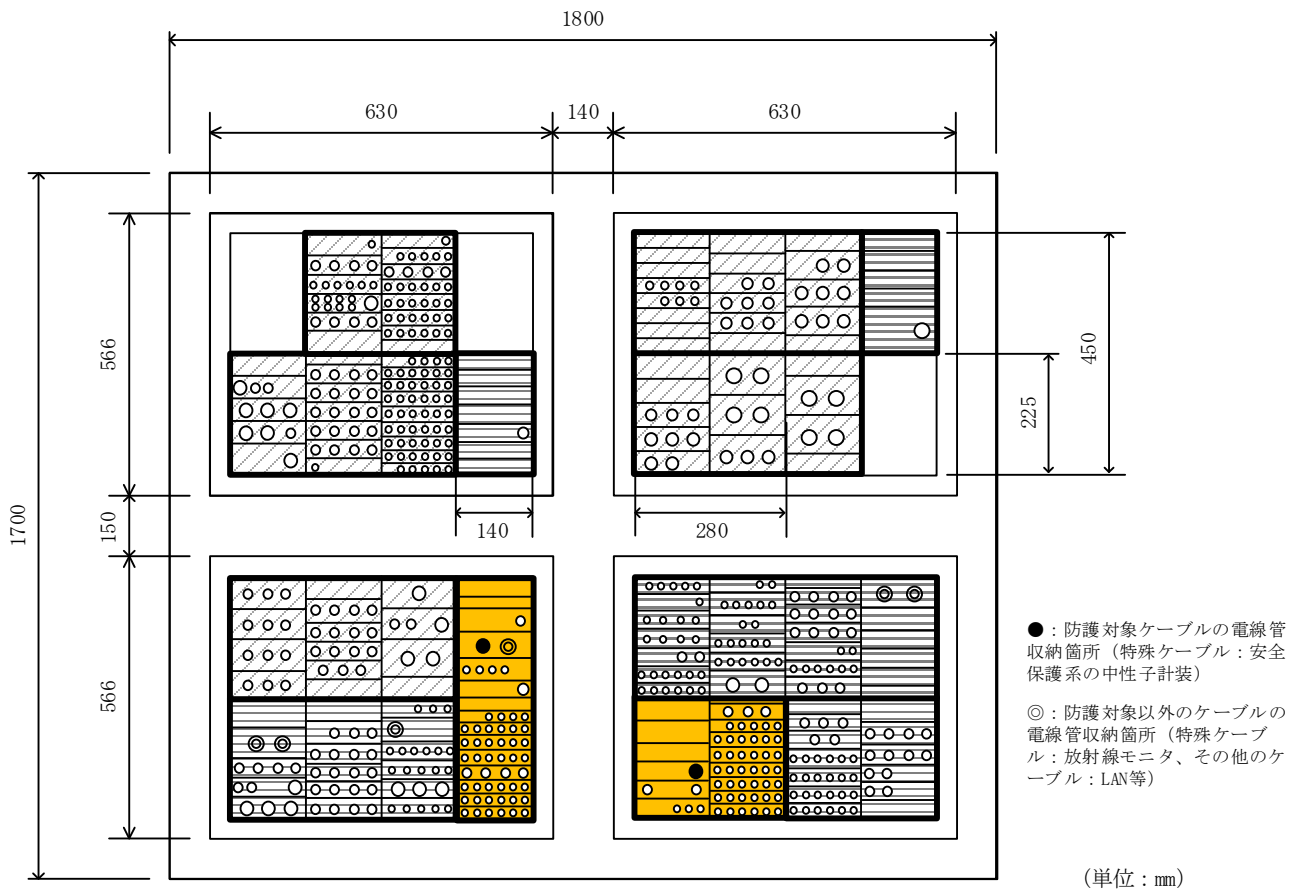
貫通部のケーブル配置図 (原子炉建家側視点)
